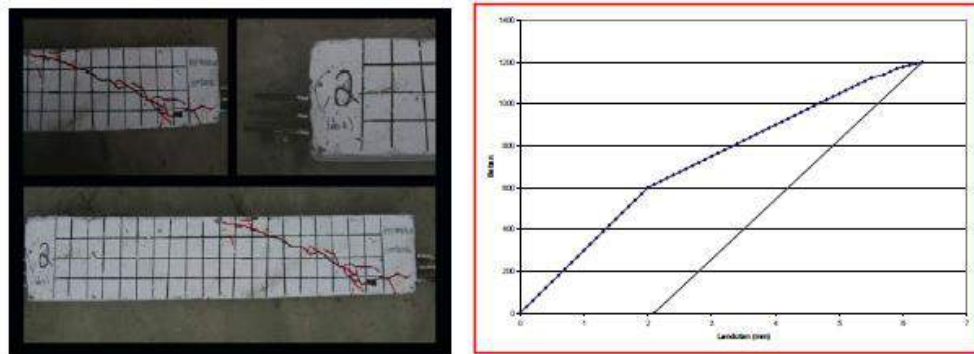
Benda Uji Balok Beton B2 dan Grafik Beban – Lendutan Balok B2
